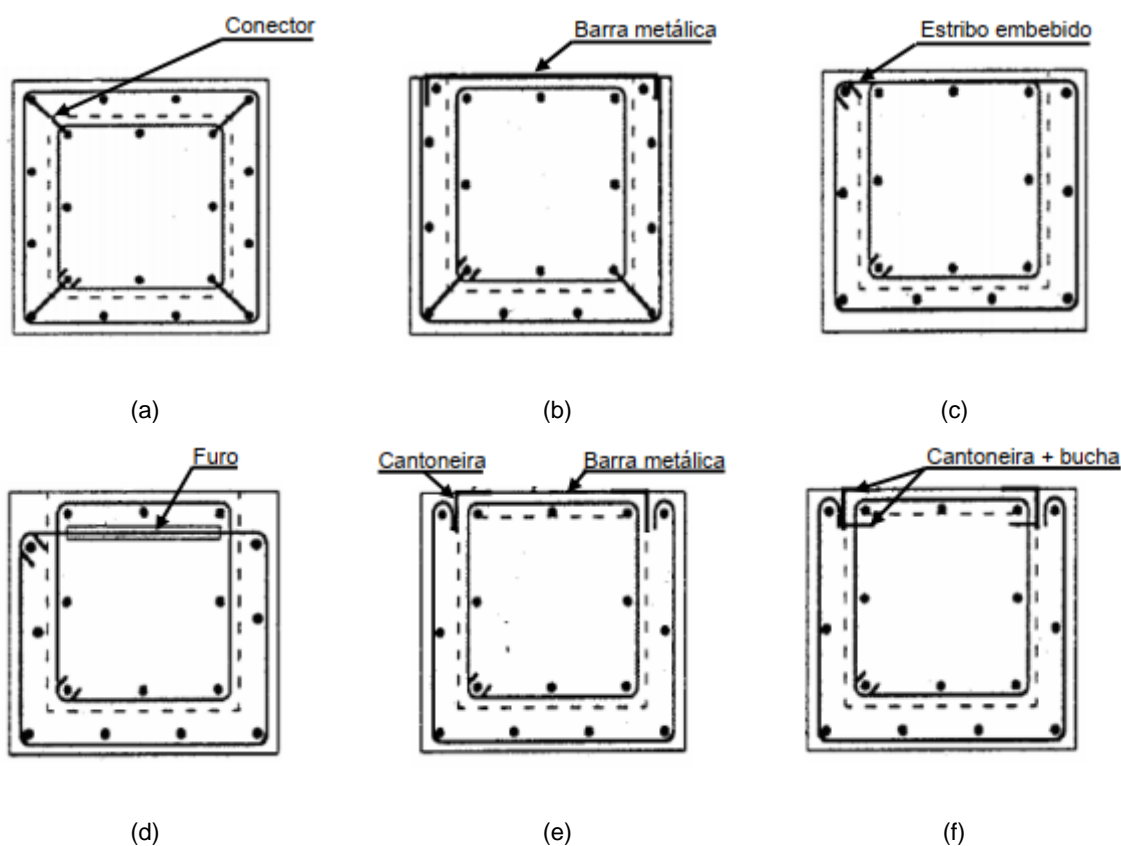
Reforço de pilares com recurso a conector (a), barra metálica (b), estribo embebido (c), a um furo (d), a cantoneira e barra metálica (e) e a cantoneira com bucha (f) - adaptado de Gomes e Appleton (1997)
